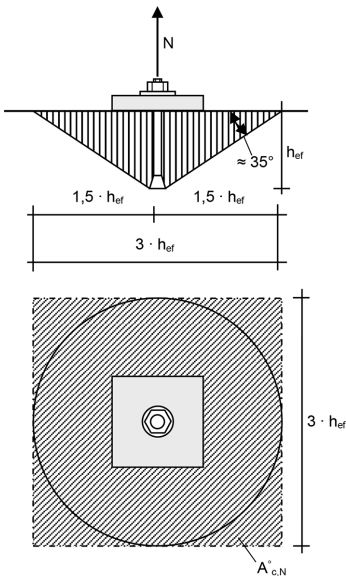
Betonausbruchkegel (schematisch) (nach [49])
